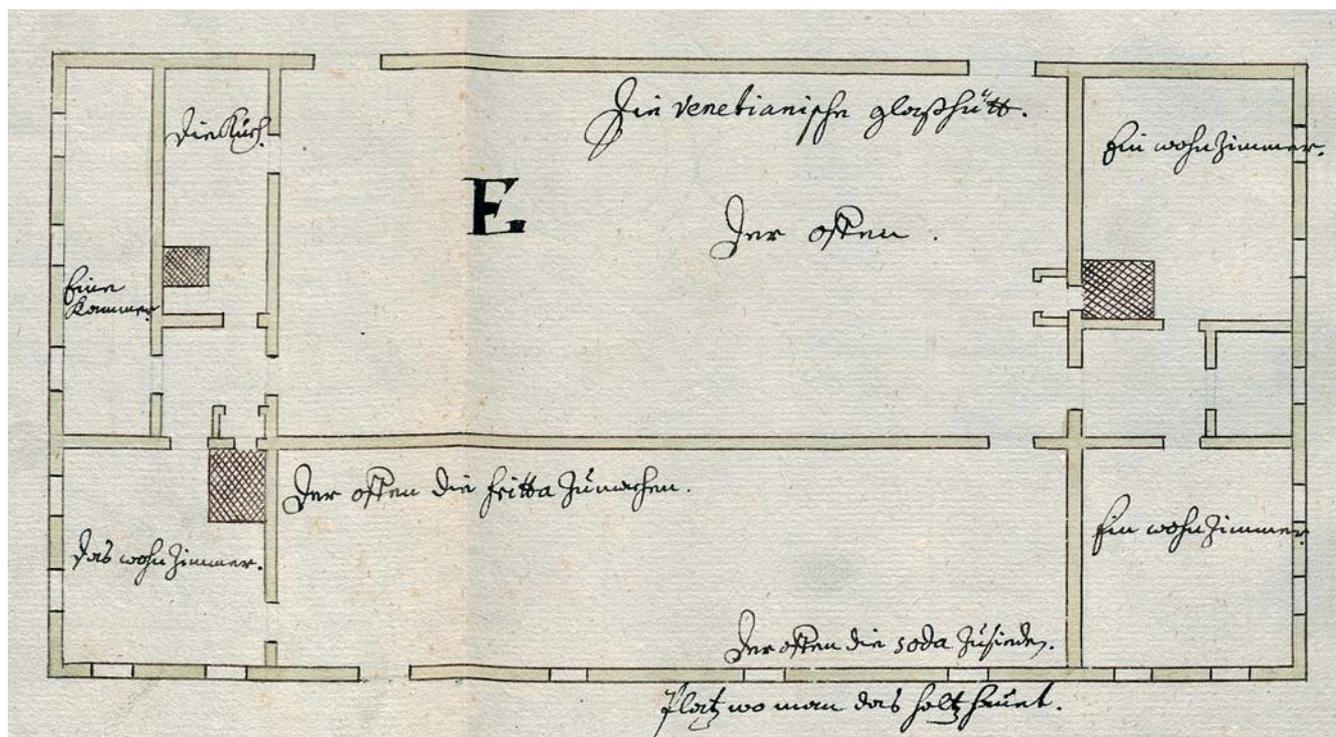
Grundriss der venezianischen Glashütte 1676 (Gebäude E). (Ausschnitt nach Becher 1676, fol. 2v; © Bildarchiv ÖNB)
